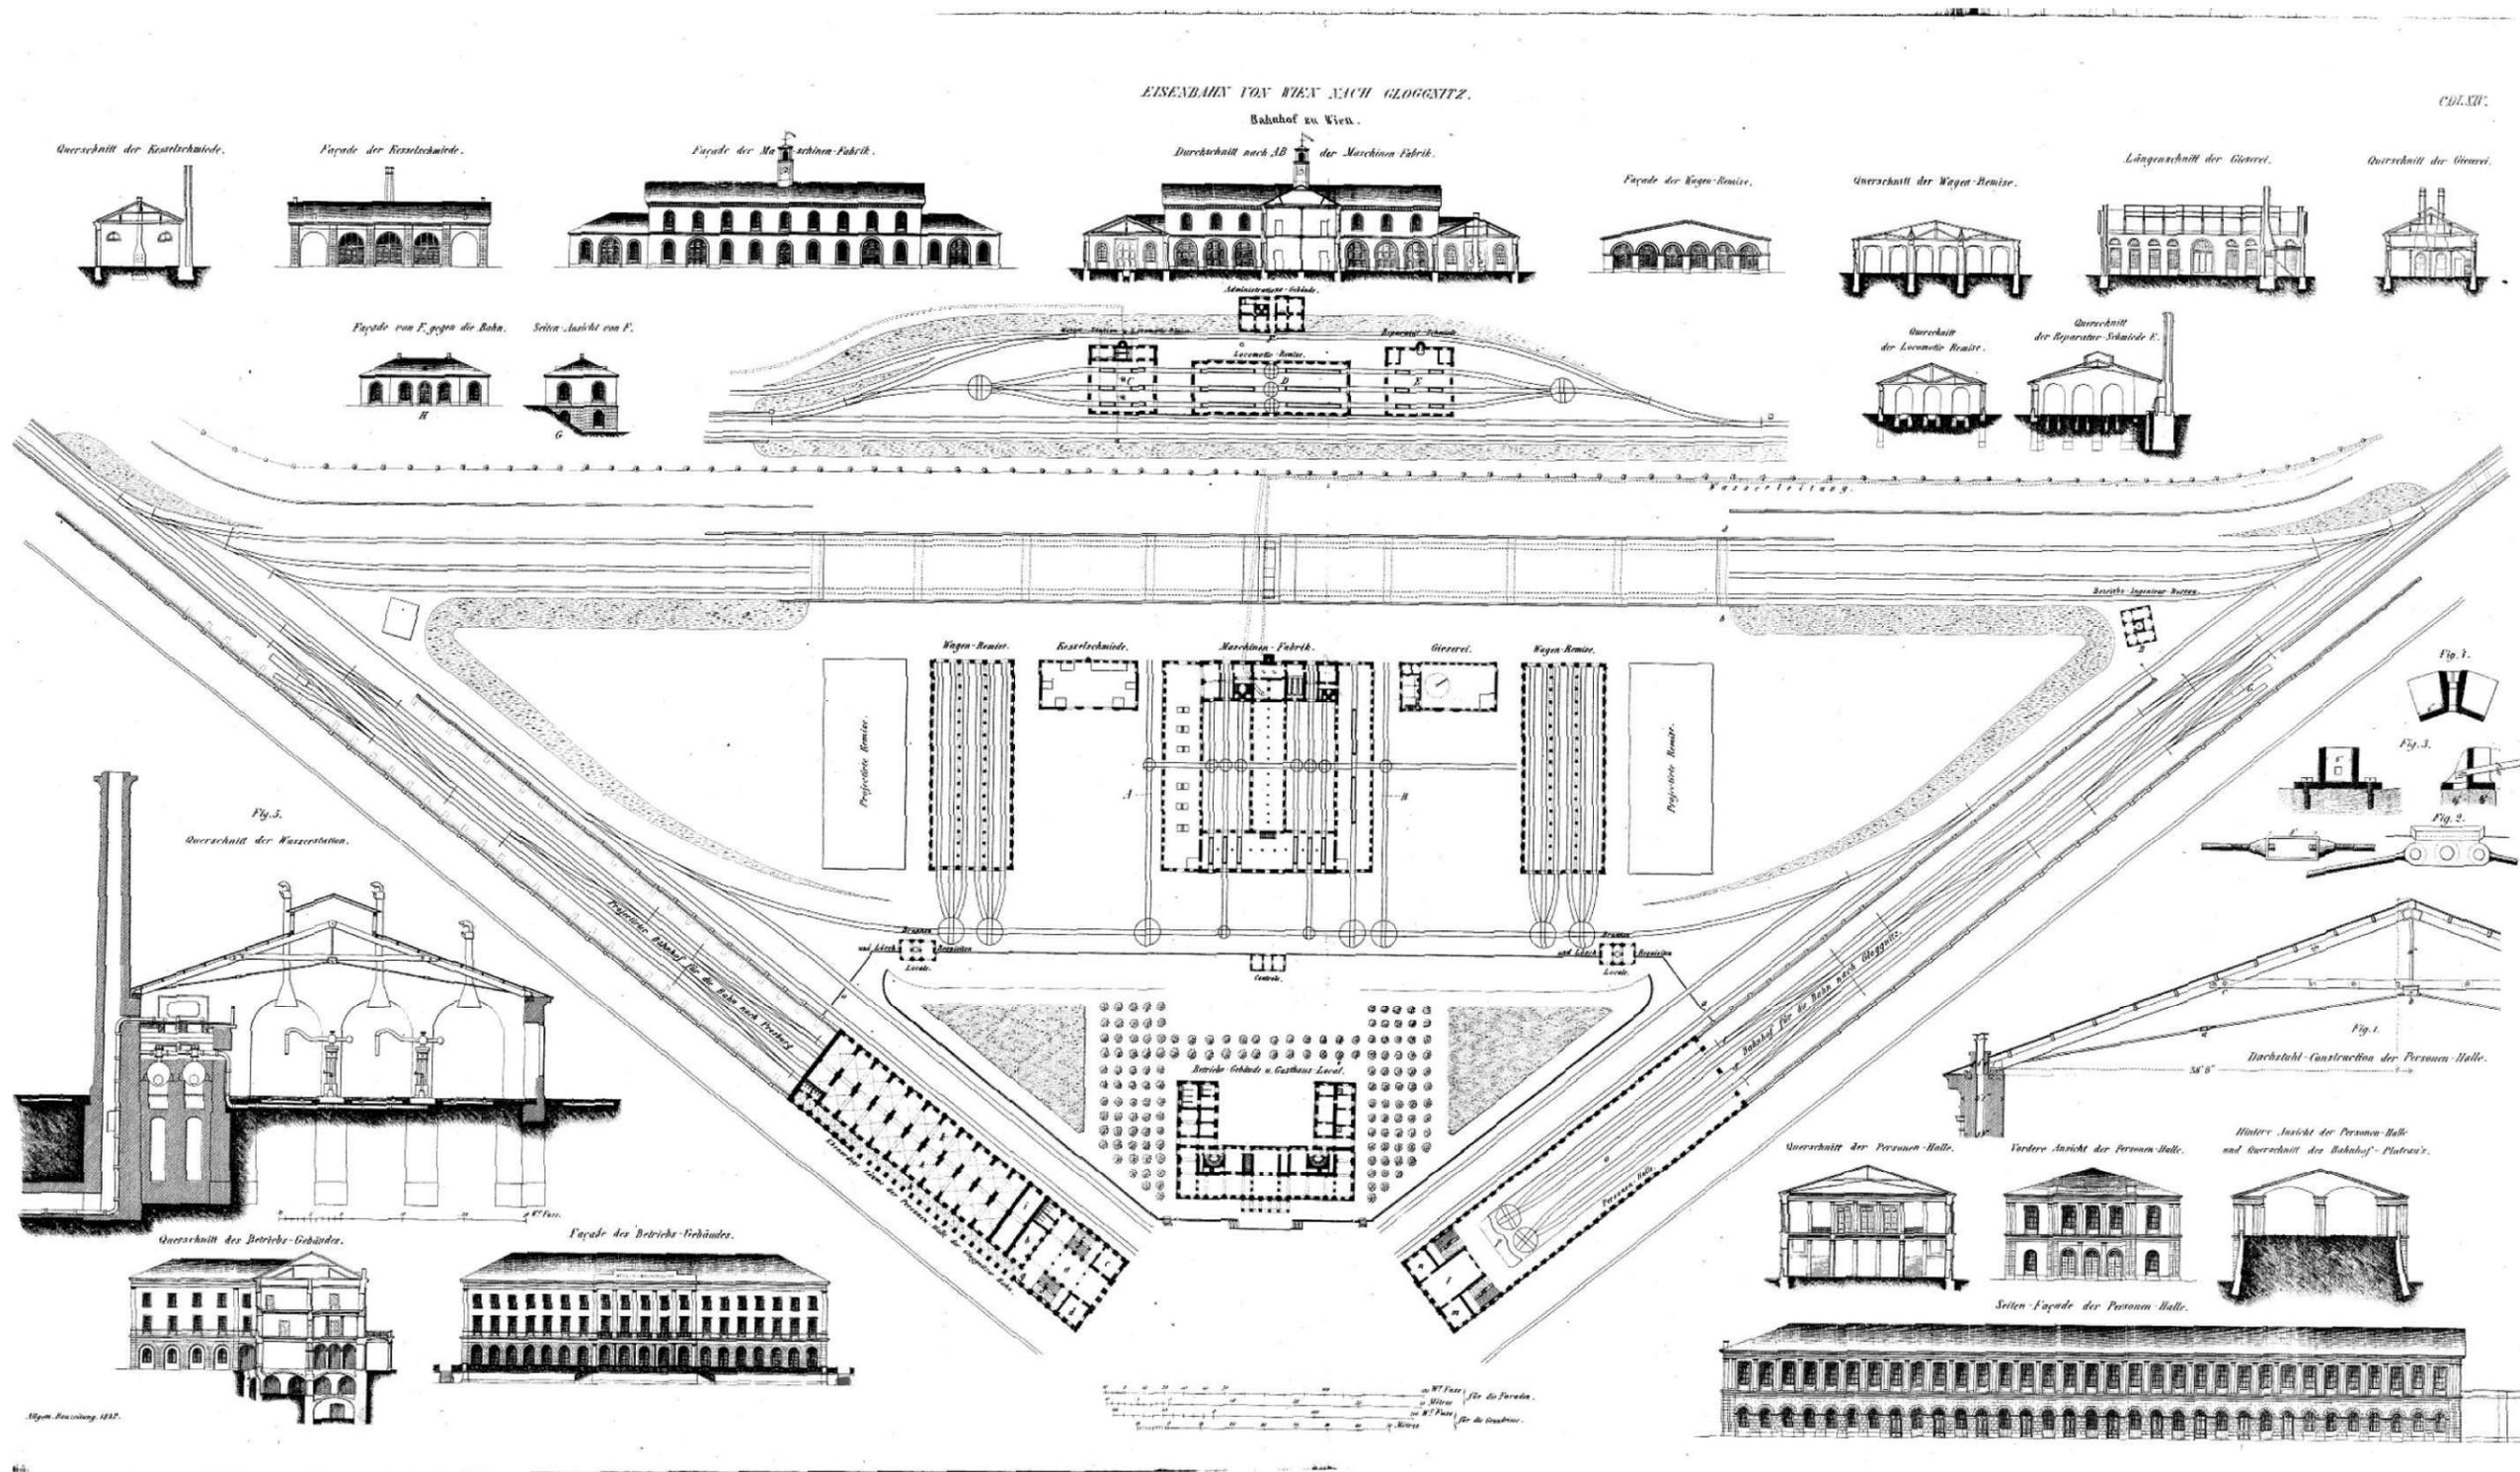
Grundriss/Schnitte der Eisenbahn von Wien nach Gloggnitz 1842
